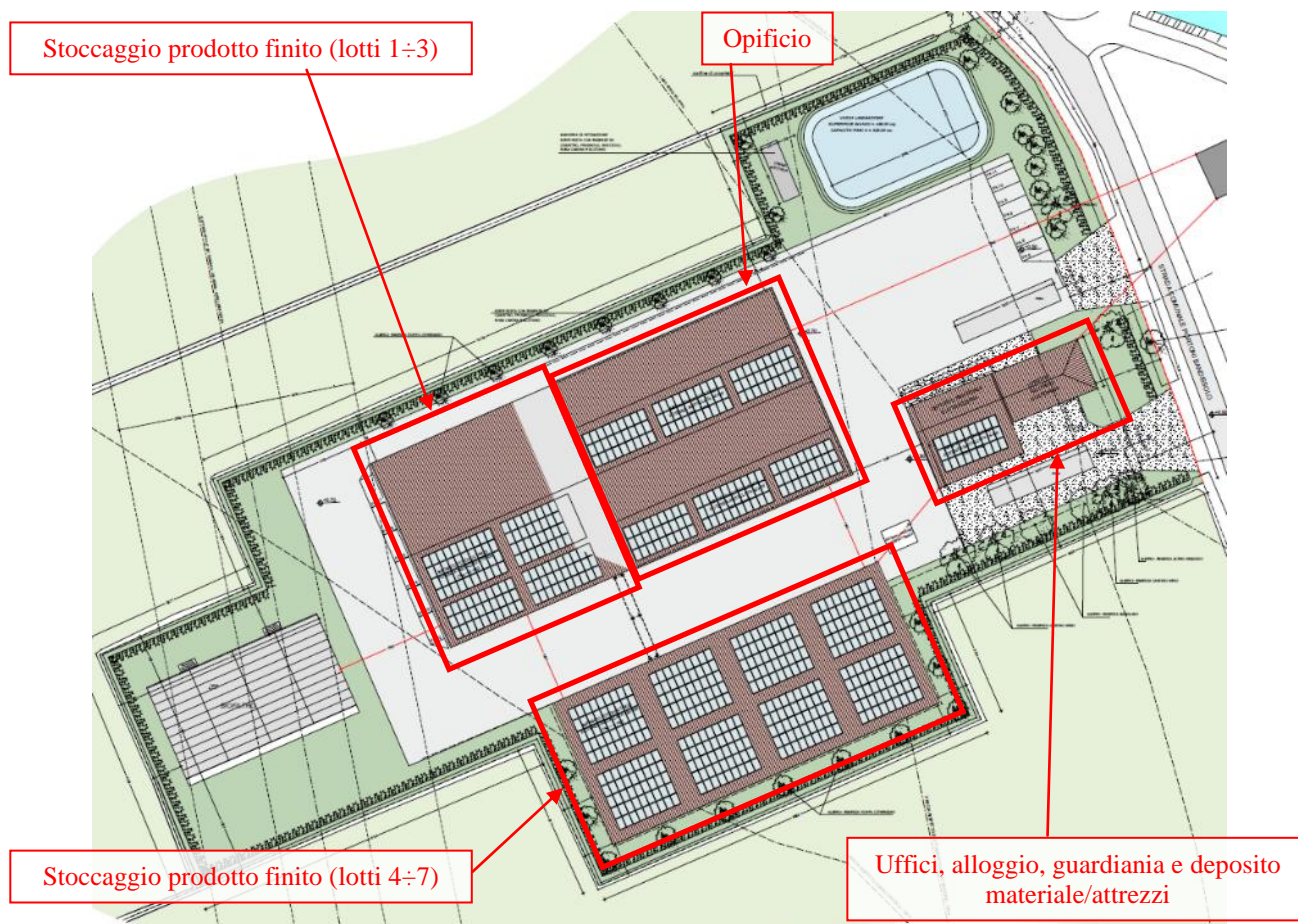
Planimetria impianto e zone coperte (stralcio Tav. 06)
